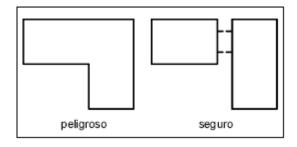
Forma óptima de la planta de una vivienda en zona sísmica
